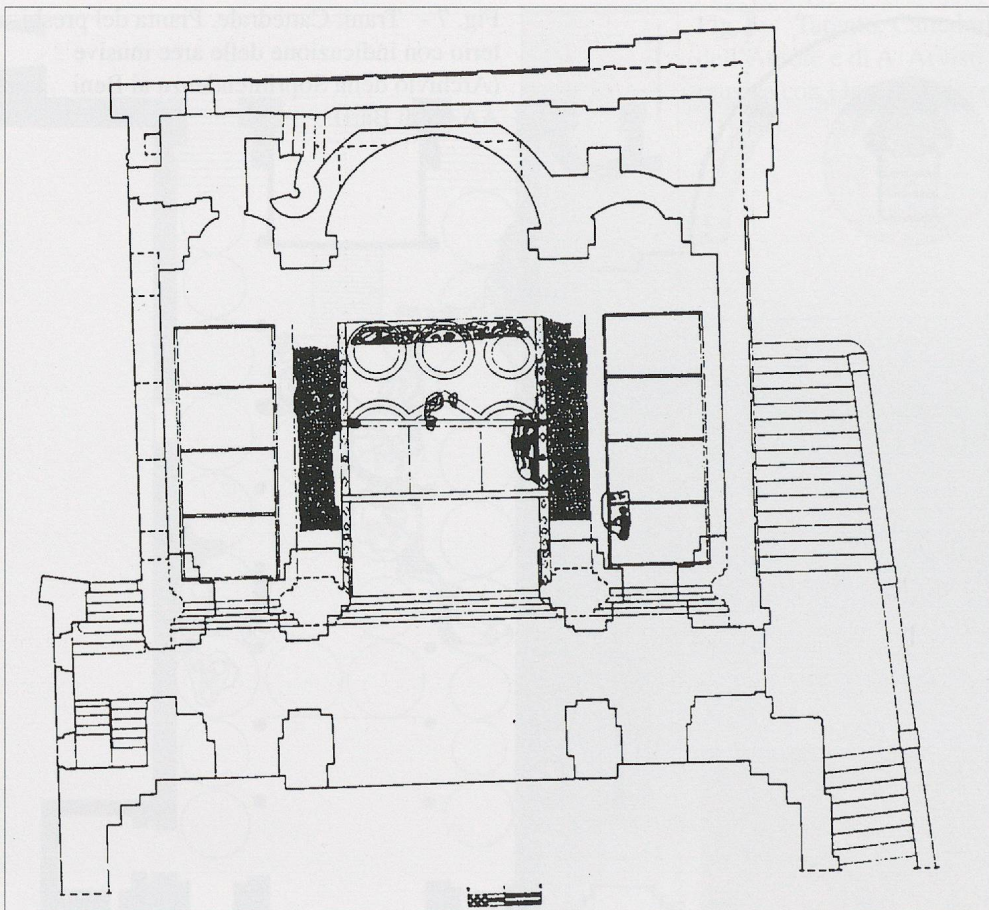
Giovinazzo, Cattedrale. Pianta del presbiterio con il pavimento musivo : ricostruzione dell'Autore e di A. Arvisti (disegno di A. Arvisti).
